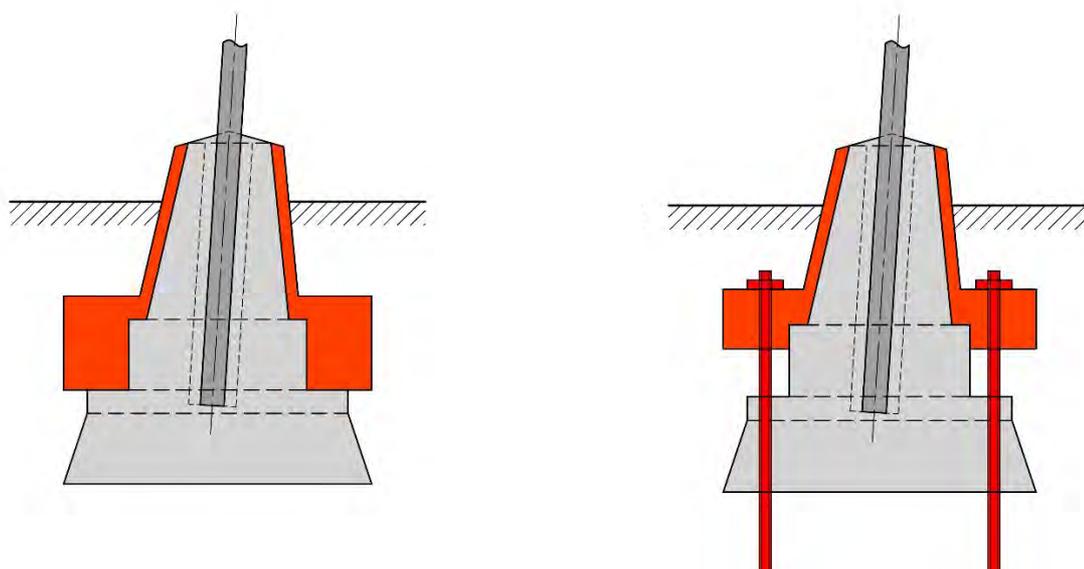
Verstärkung mit einfachem Betonkragen (links), Verstärkung mit Betonkragen und Mikropfählen (rechts).
